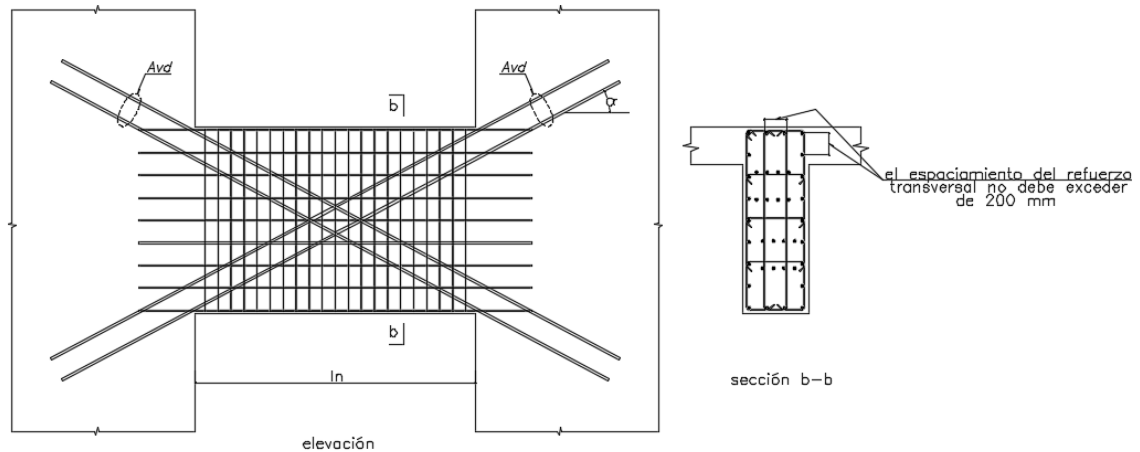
ii Refuerzo alternativo de vigas de acople
